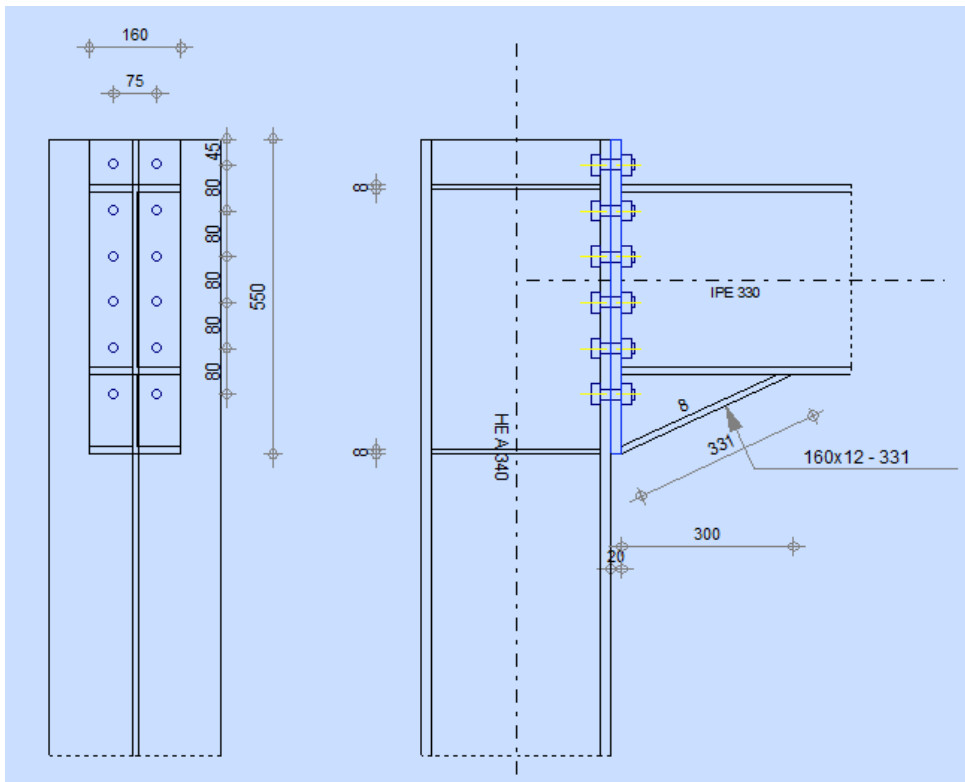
Disposition constructif de l'assemblage poteau - poutre.
